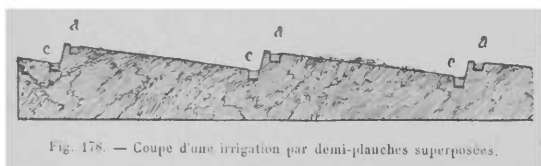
Coupe d'une irrigation par demi-planches superposées.
